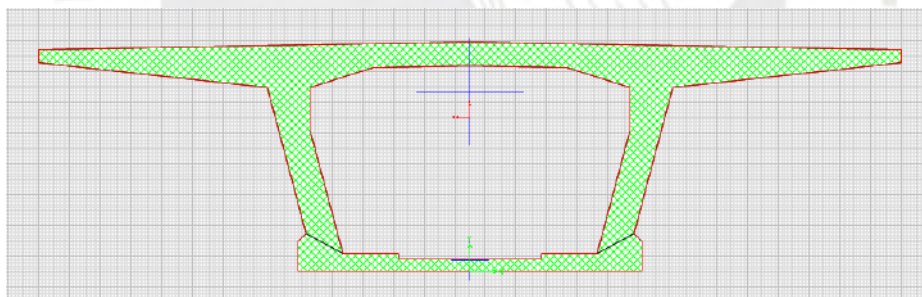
Sección del Cajón de Hormigón en Centro de Vano
